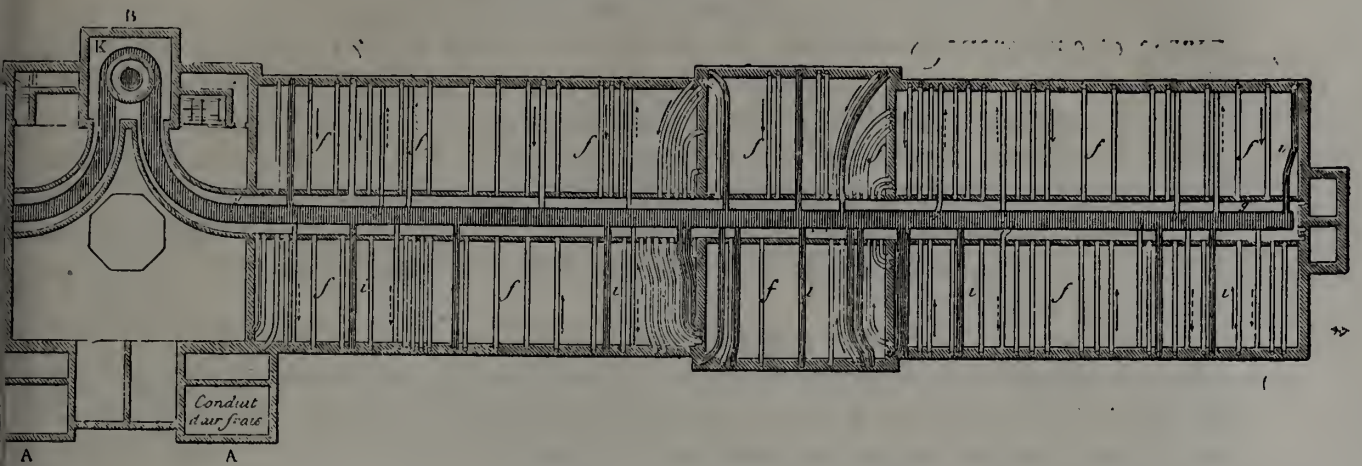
Plan du comble suivant AB de la coupe verticale.
